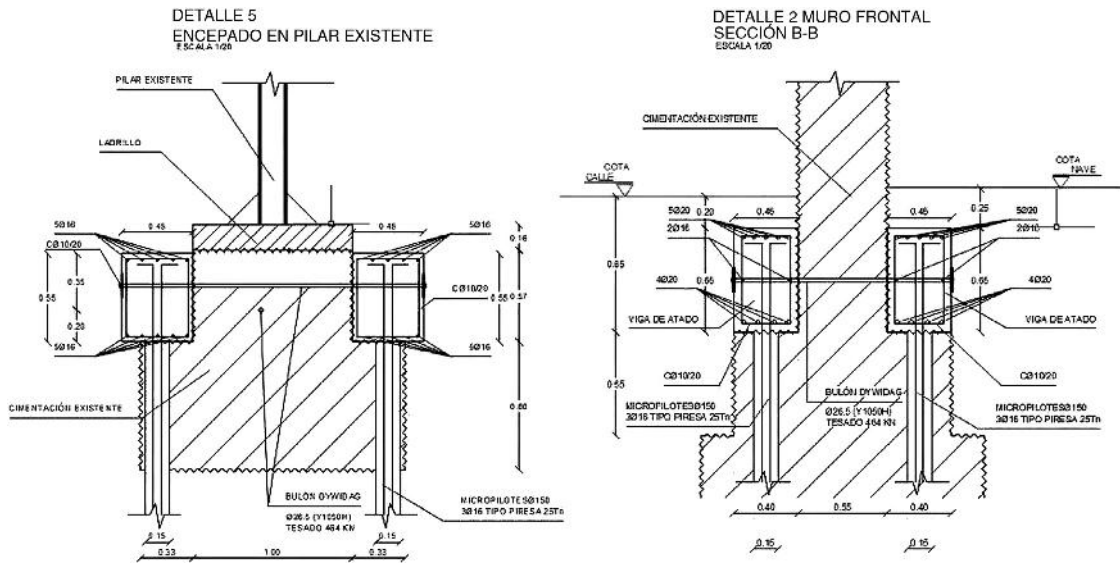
Detalles del recalce mediante micropilotes de las cimentaciones de los muros existentes.
